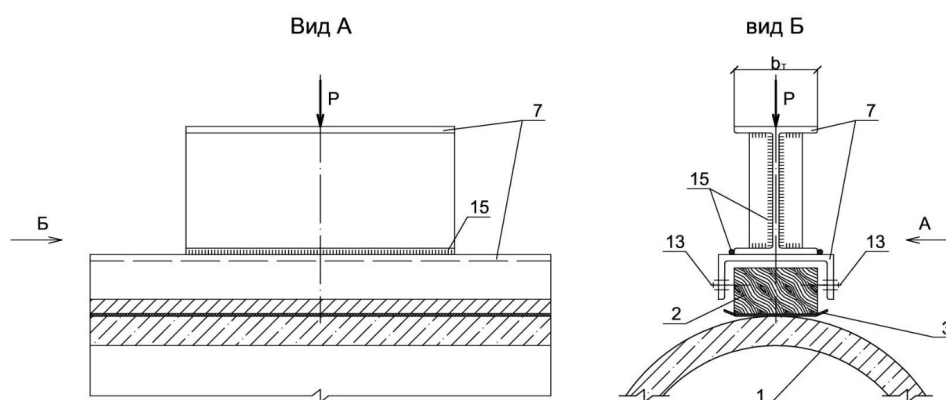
К расчету стальных элементов металло-деревянной траверсы: 1 – стеновое кольцо; 2 – деревянный брусок; 3 – резиновая прокладка; 7 – упорная составная стальная балка силовой рамы; 13 – установочные винты; 15 – сварные швы; P – нагрузка от грузового домкрата, кН
